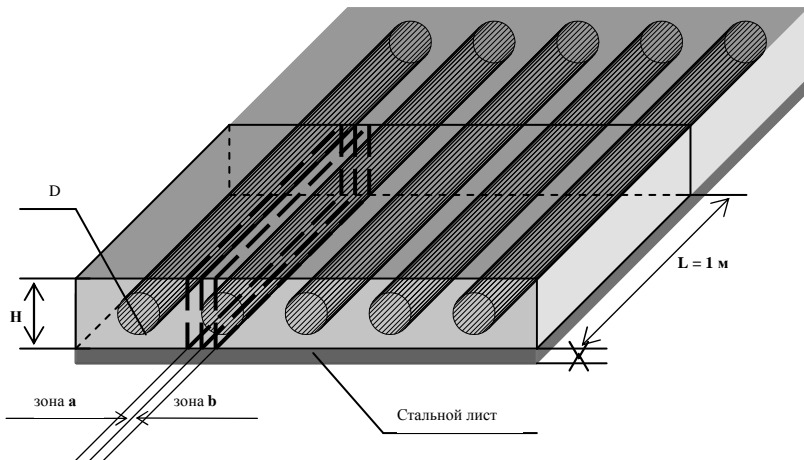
Схема поперечного сечения плиты перекрытия с продольными пустотами цилиндрической формы
